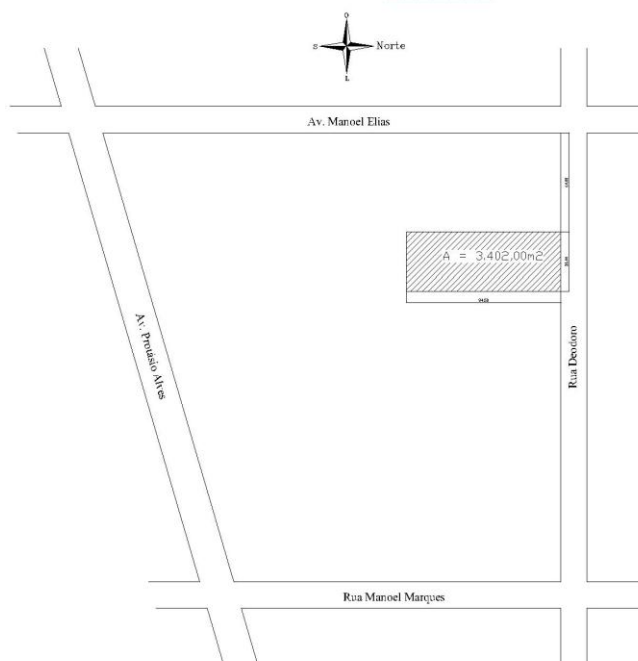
Plano de implantación del conjunto de edificios Amizade.
